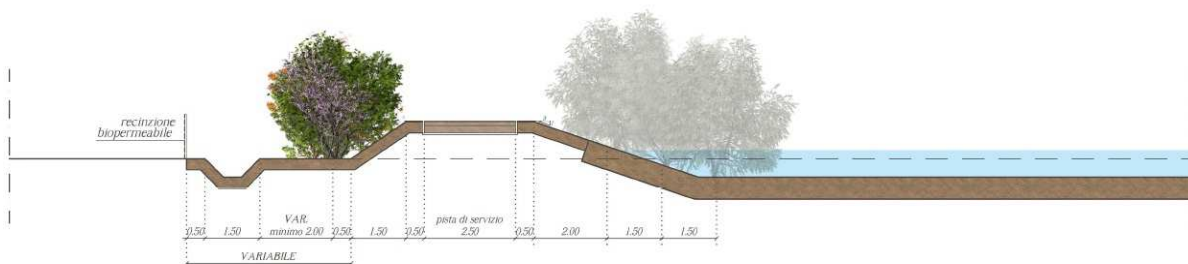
TIPOLOGIA A – SEZIONE TIPO
